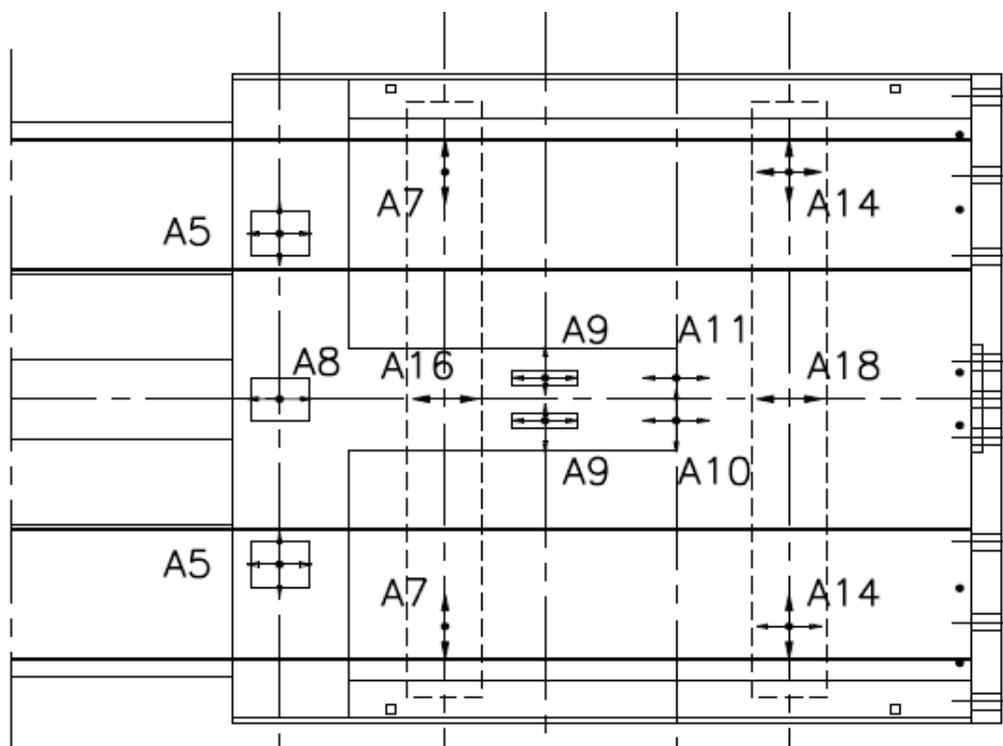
Disposizione degli appoggi alla struttura terminale lato Calabria
